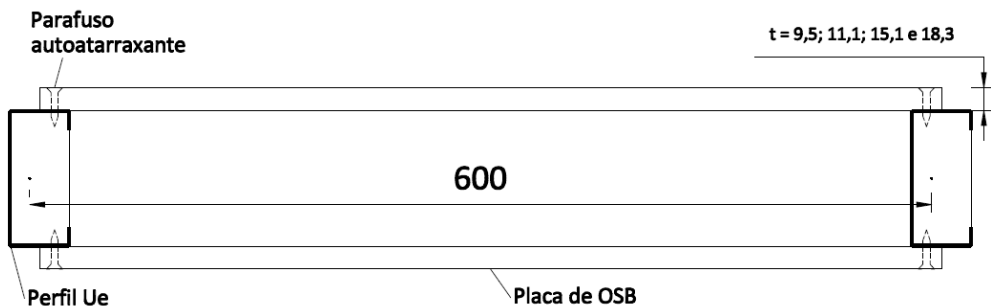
Vista em planta do Modelo 2 para o ensaio de "push-out".
